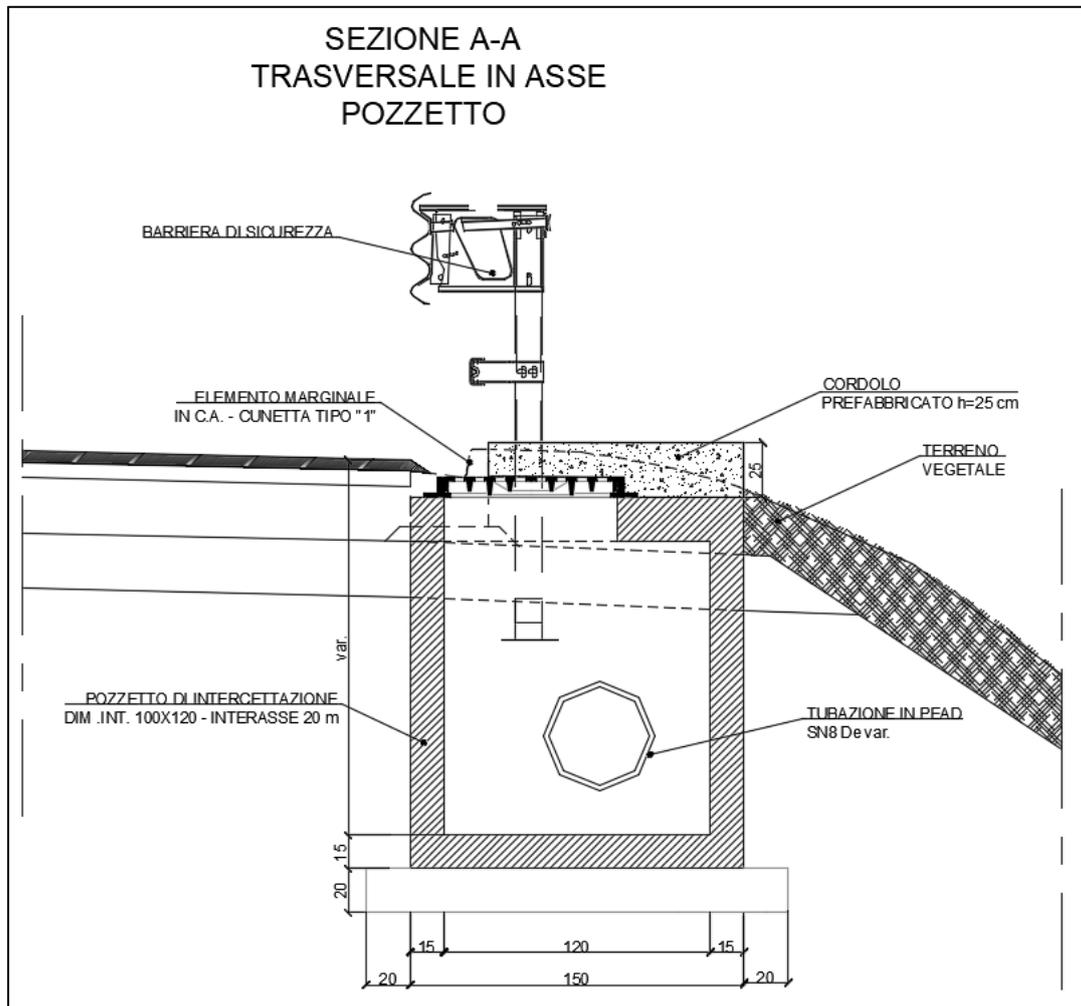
Sistema di scarico in rilevato – sezione trasversale asse pozzetto
